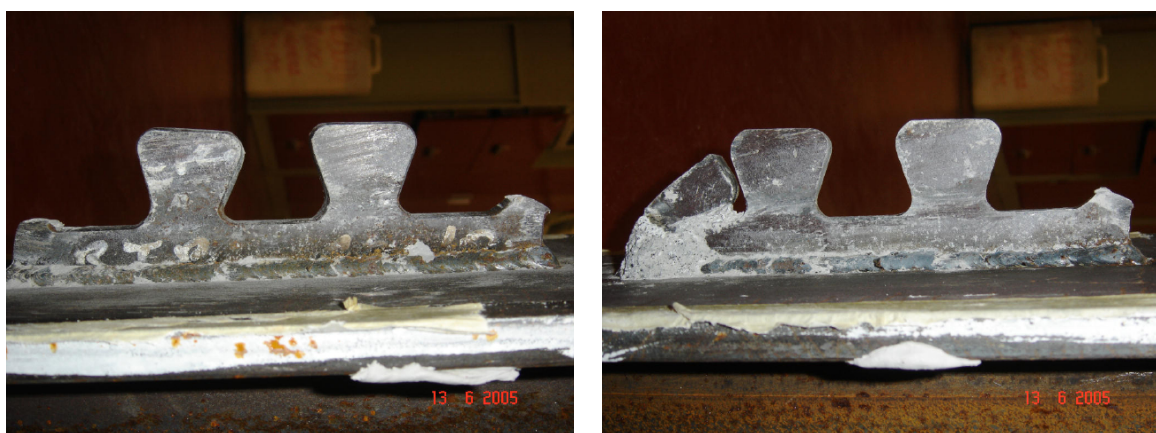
Estado dos conectores do modelo A1 ao final do ensaio.
